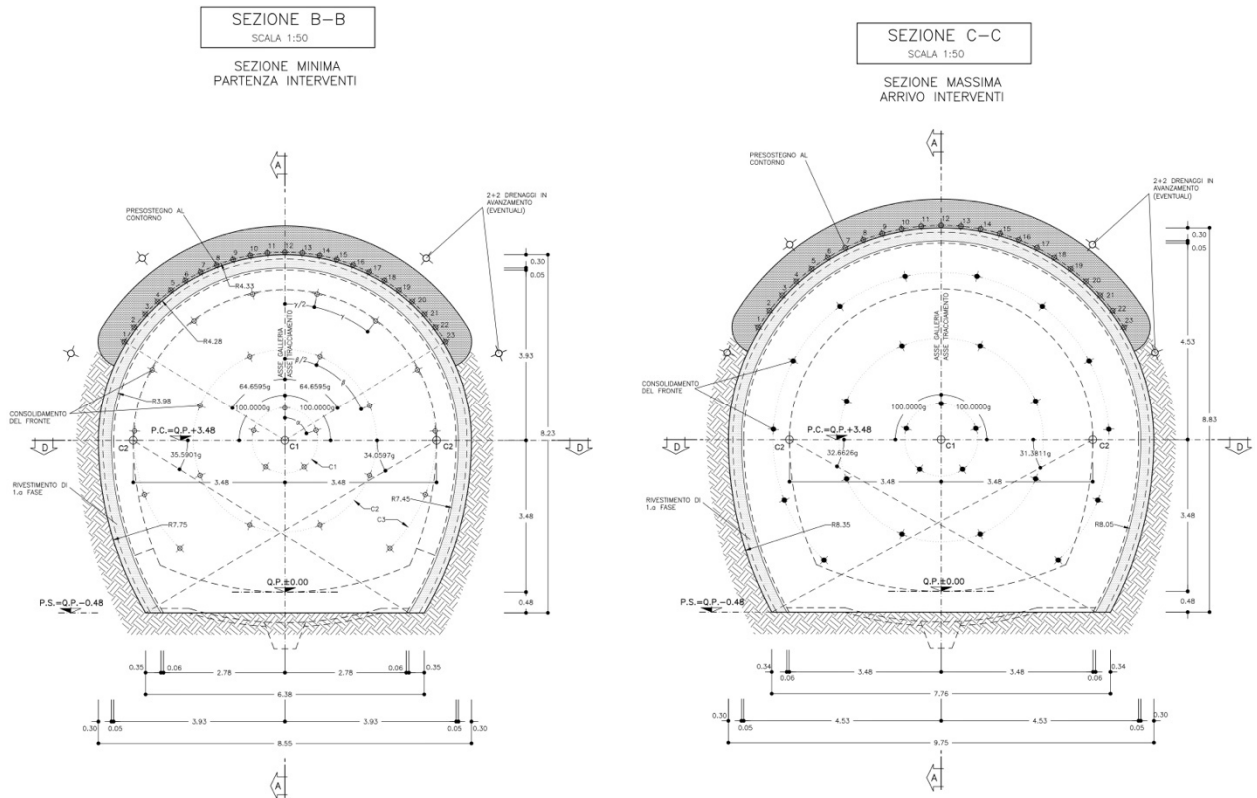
Sezione Tipo B2V – Scavi e consolidamenti - Sezione
